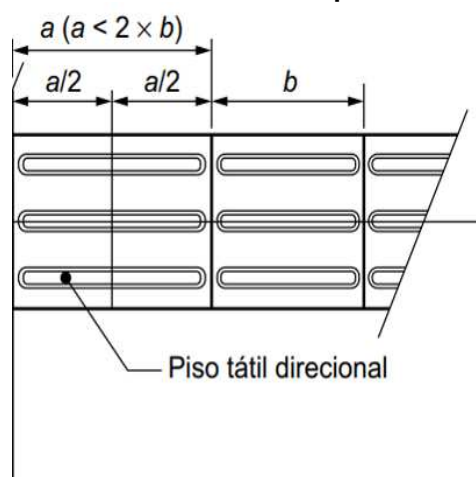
Piso tátil a ser instalado no interior da edificação
